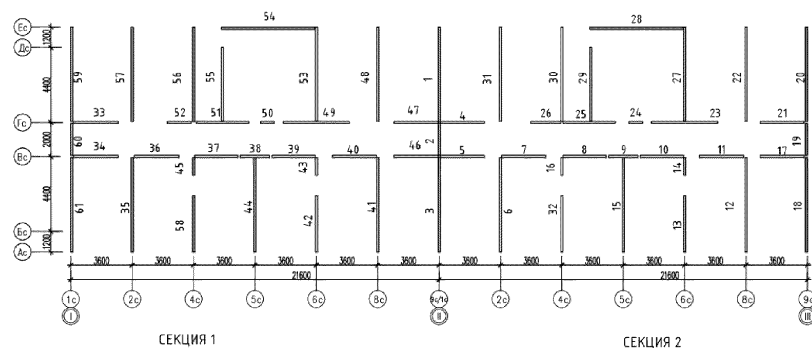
Номера простенков 2-го этажа жилого дома
